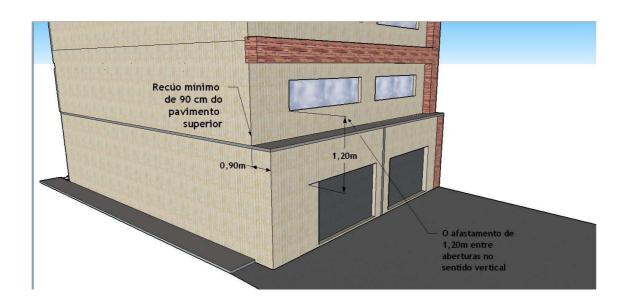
Recuo mínimo de 90 centímetros do pavimento superior
